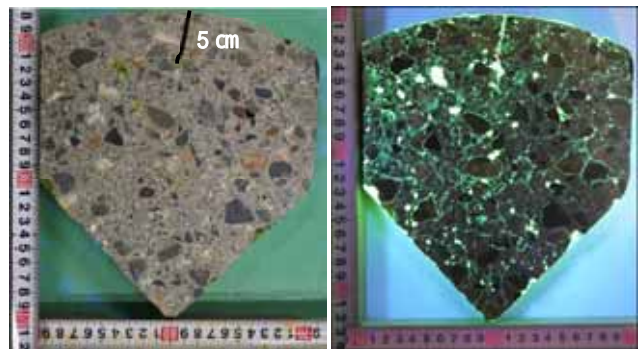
(b) 円柱表面に入ったASR劣化ひび割れ (ケース 終了後の供試体内部のひび割れ状況)
